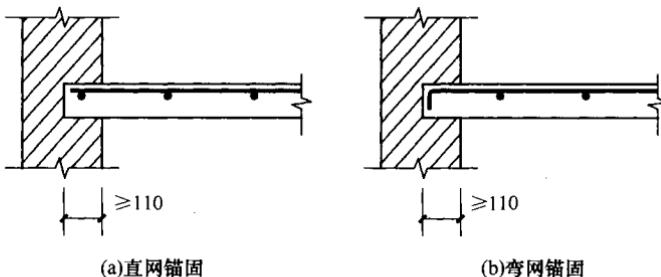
板上部受力钢筋焊接网的锚固
